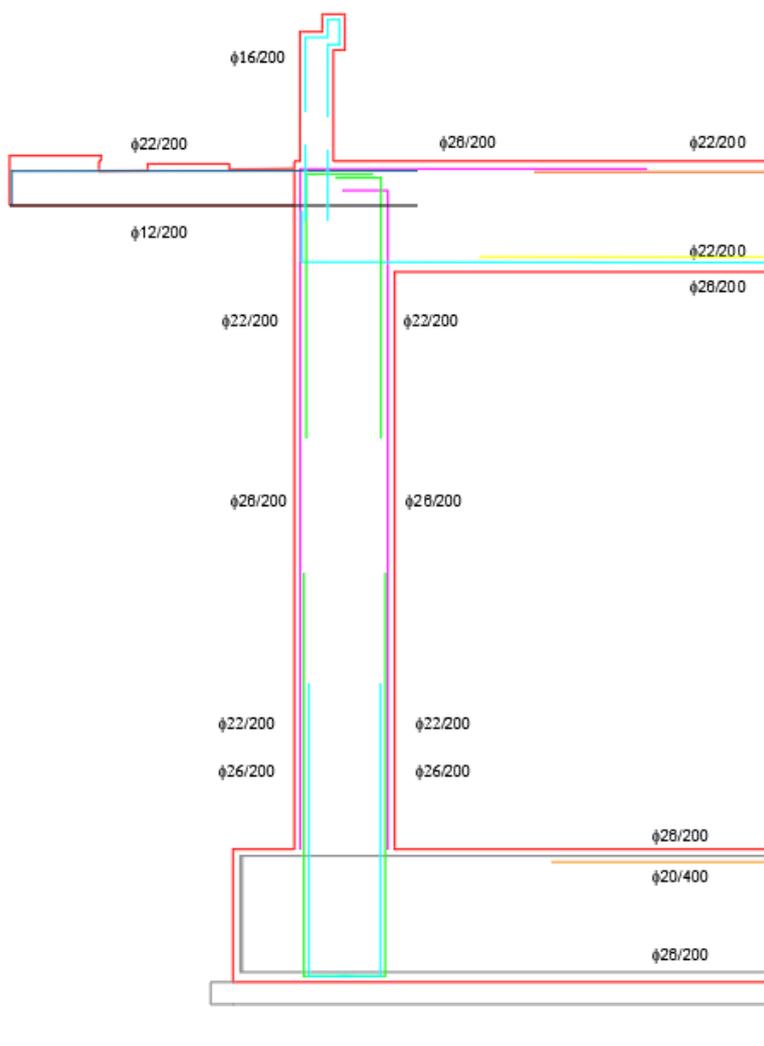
Schema indicativo armature sezione corrente scatolare
